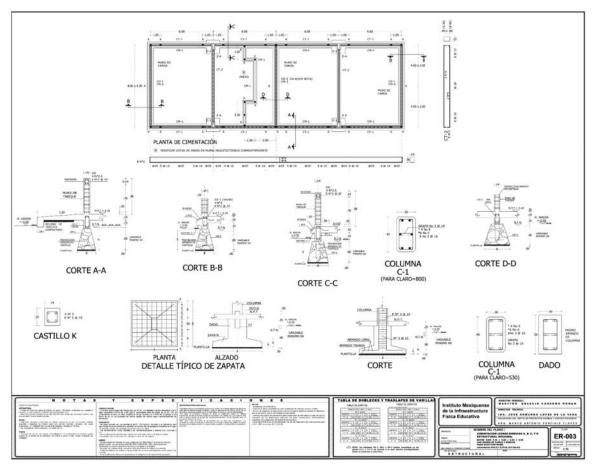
Plano de armado de zapatas, castillos, columnas y contra trabes.
